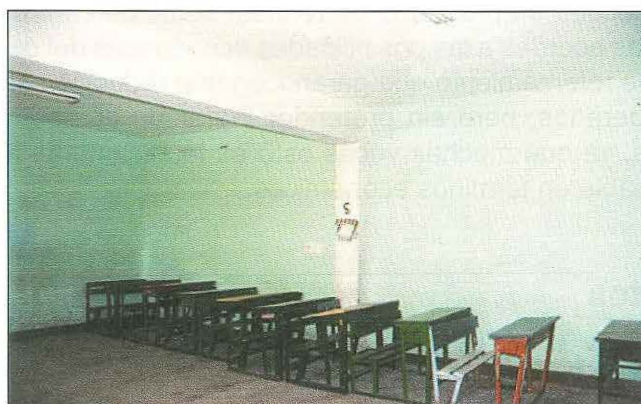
Muro longitudinal de cierre que controló el desplazamiento lateral y evitó el problema de columna corta en un pabellón aporticado tradicional.
